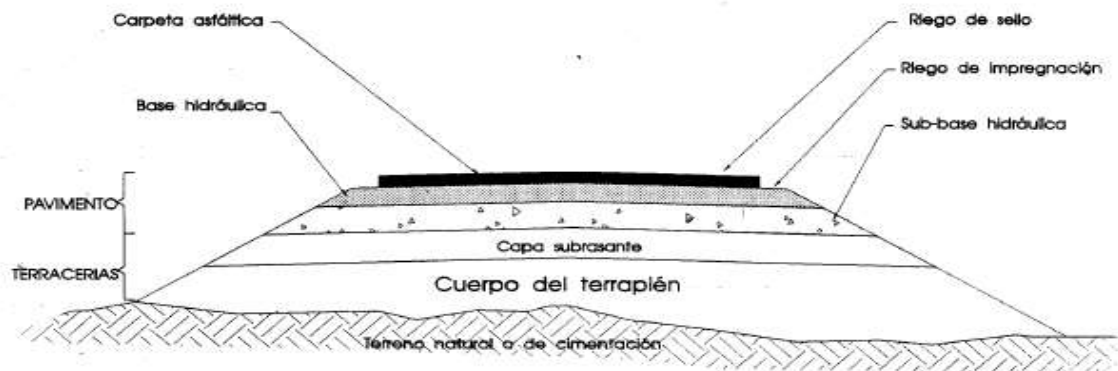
Pavimento Flexible de la Carretera al Chaco
